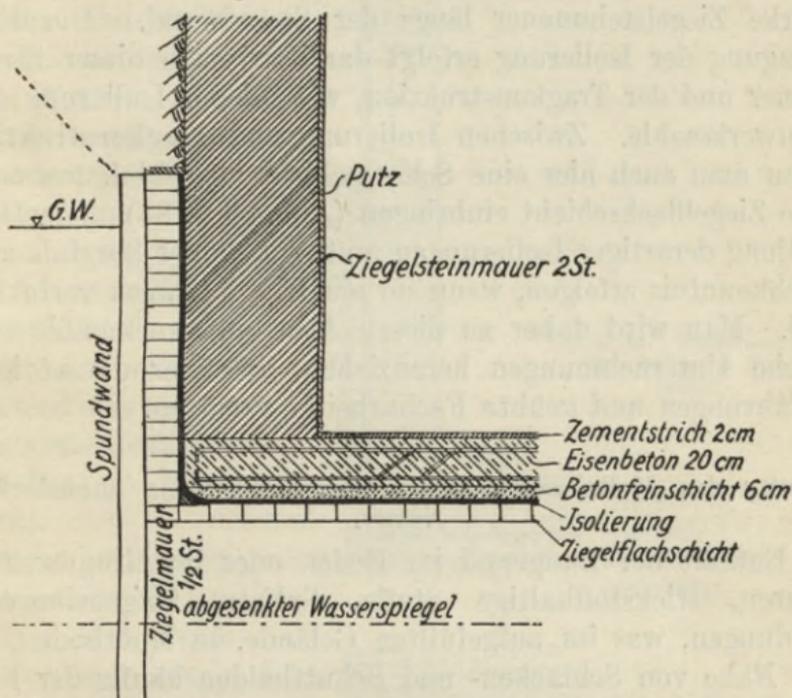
Grundwasserabdichtung eines Kellers bei abgespundeter Baugrube.
